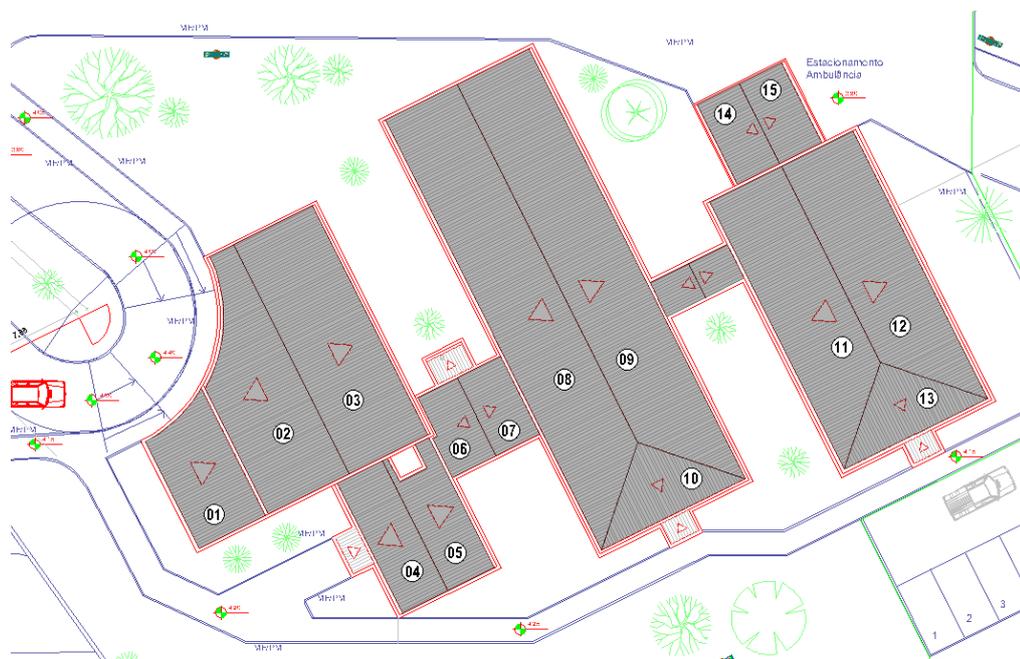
Planta de Cobertura dividida em quinze áreas principais para instalação dos painéis solares (sem escala).
